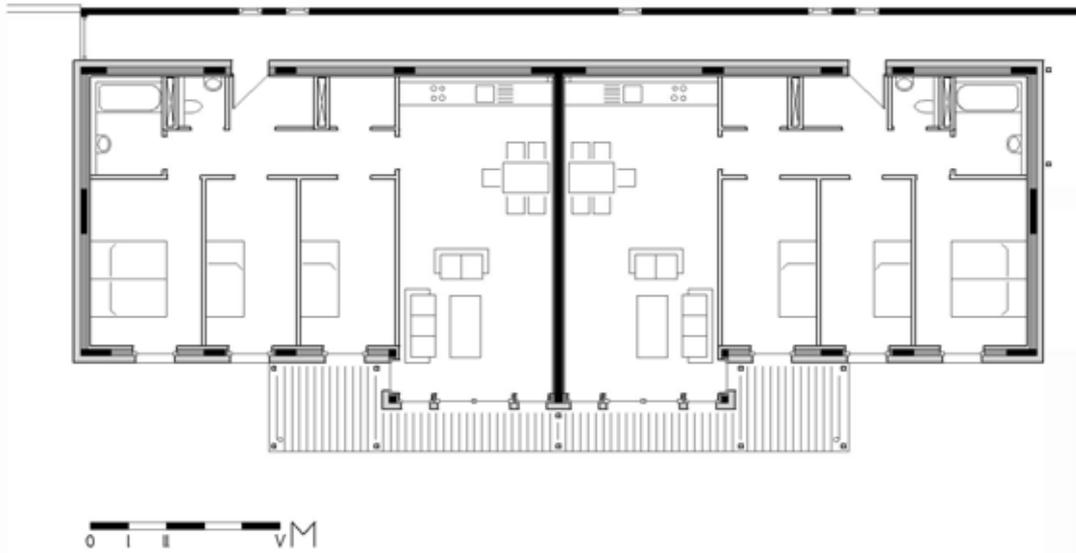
Grundriss Block A, 3.Obergeschoss
